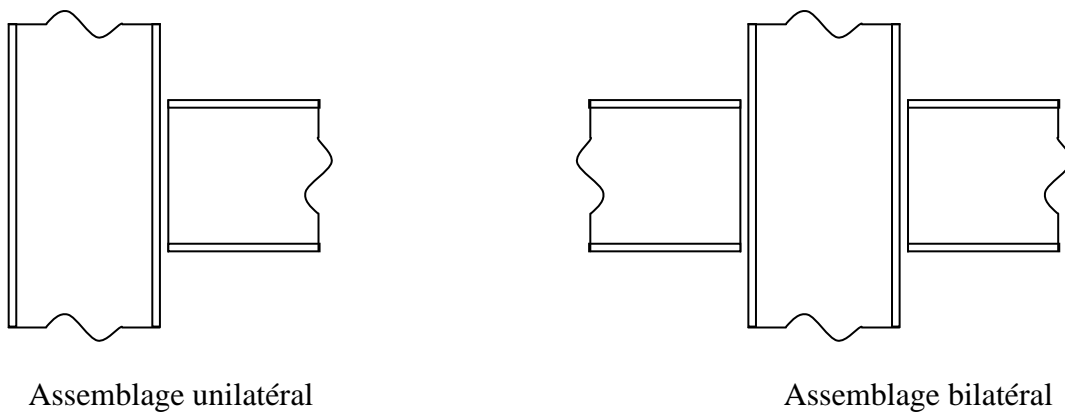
Configurations des assemblages poteau poutre dans le plan.
